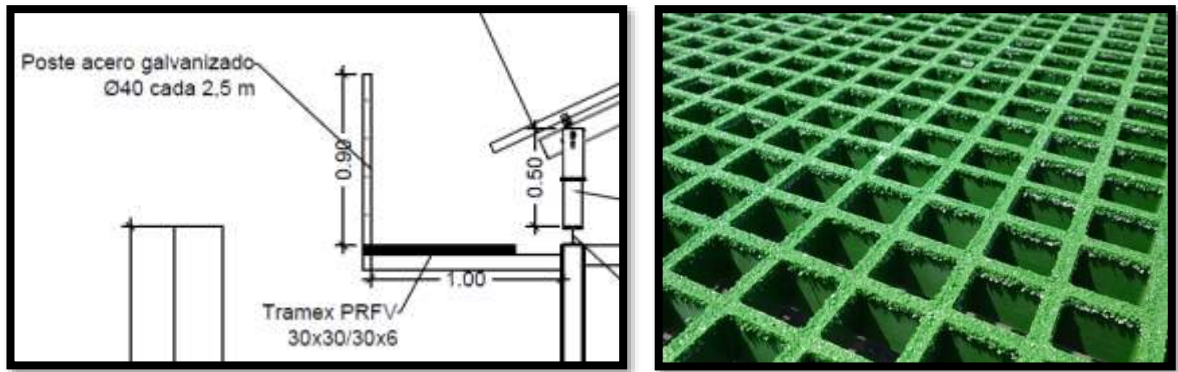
Esquema pasillo de acceso (izquierda) y material utilizado (derecha).
